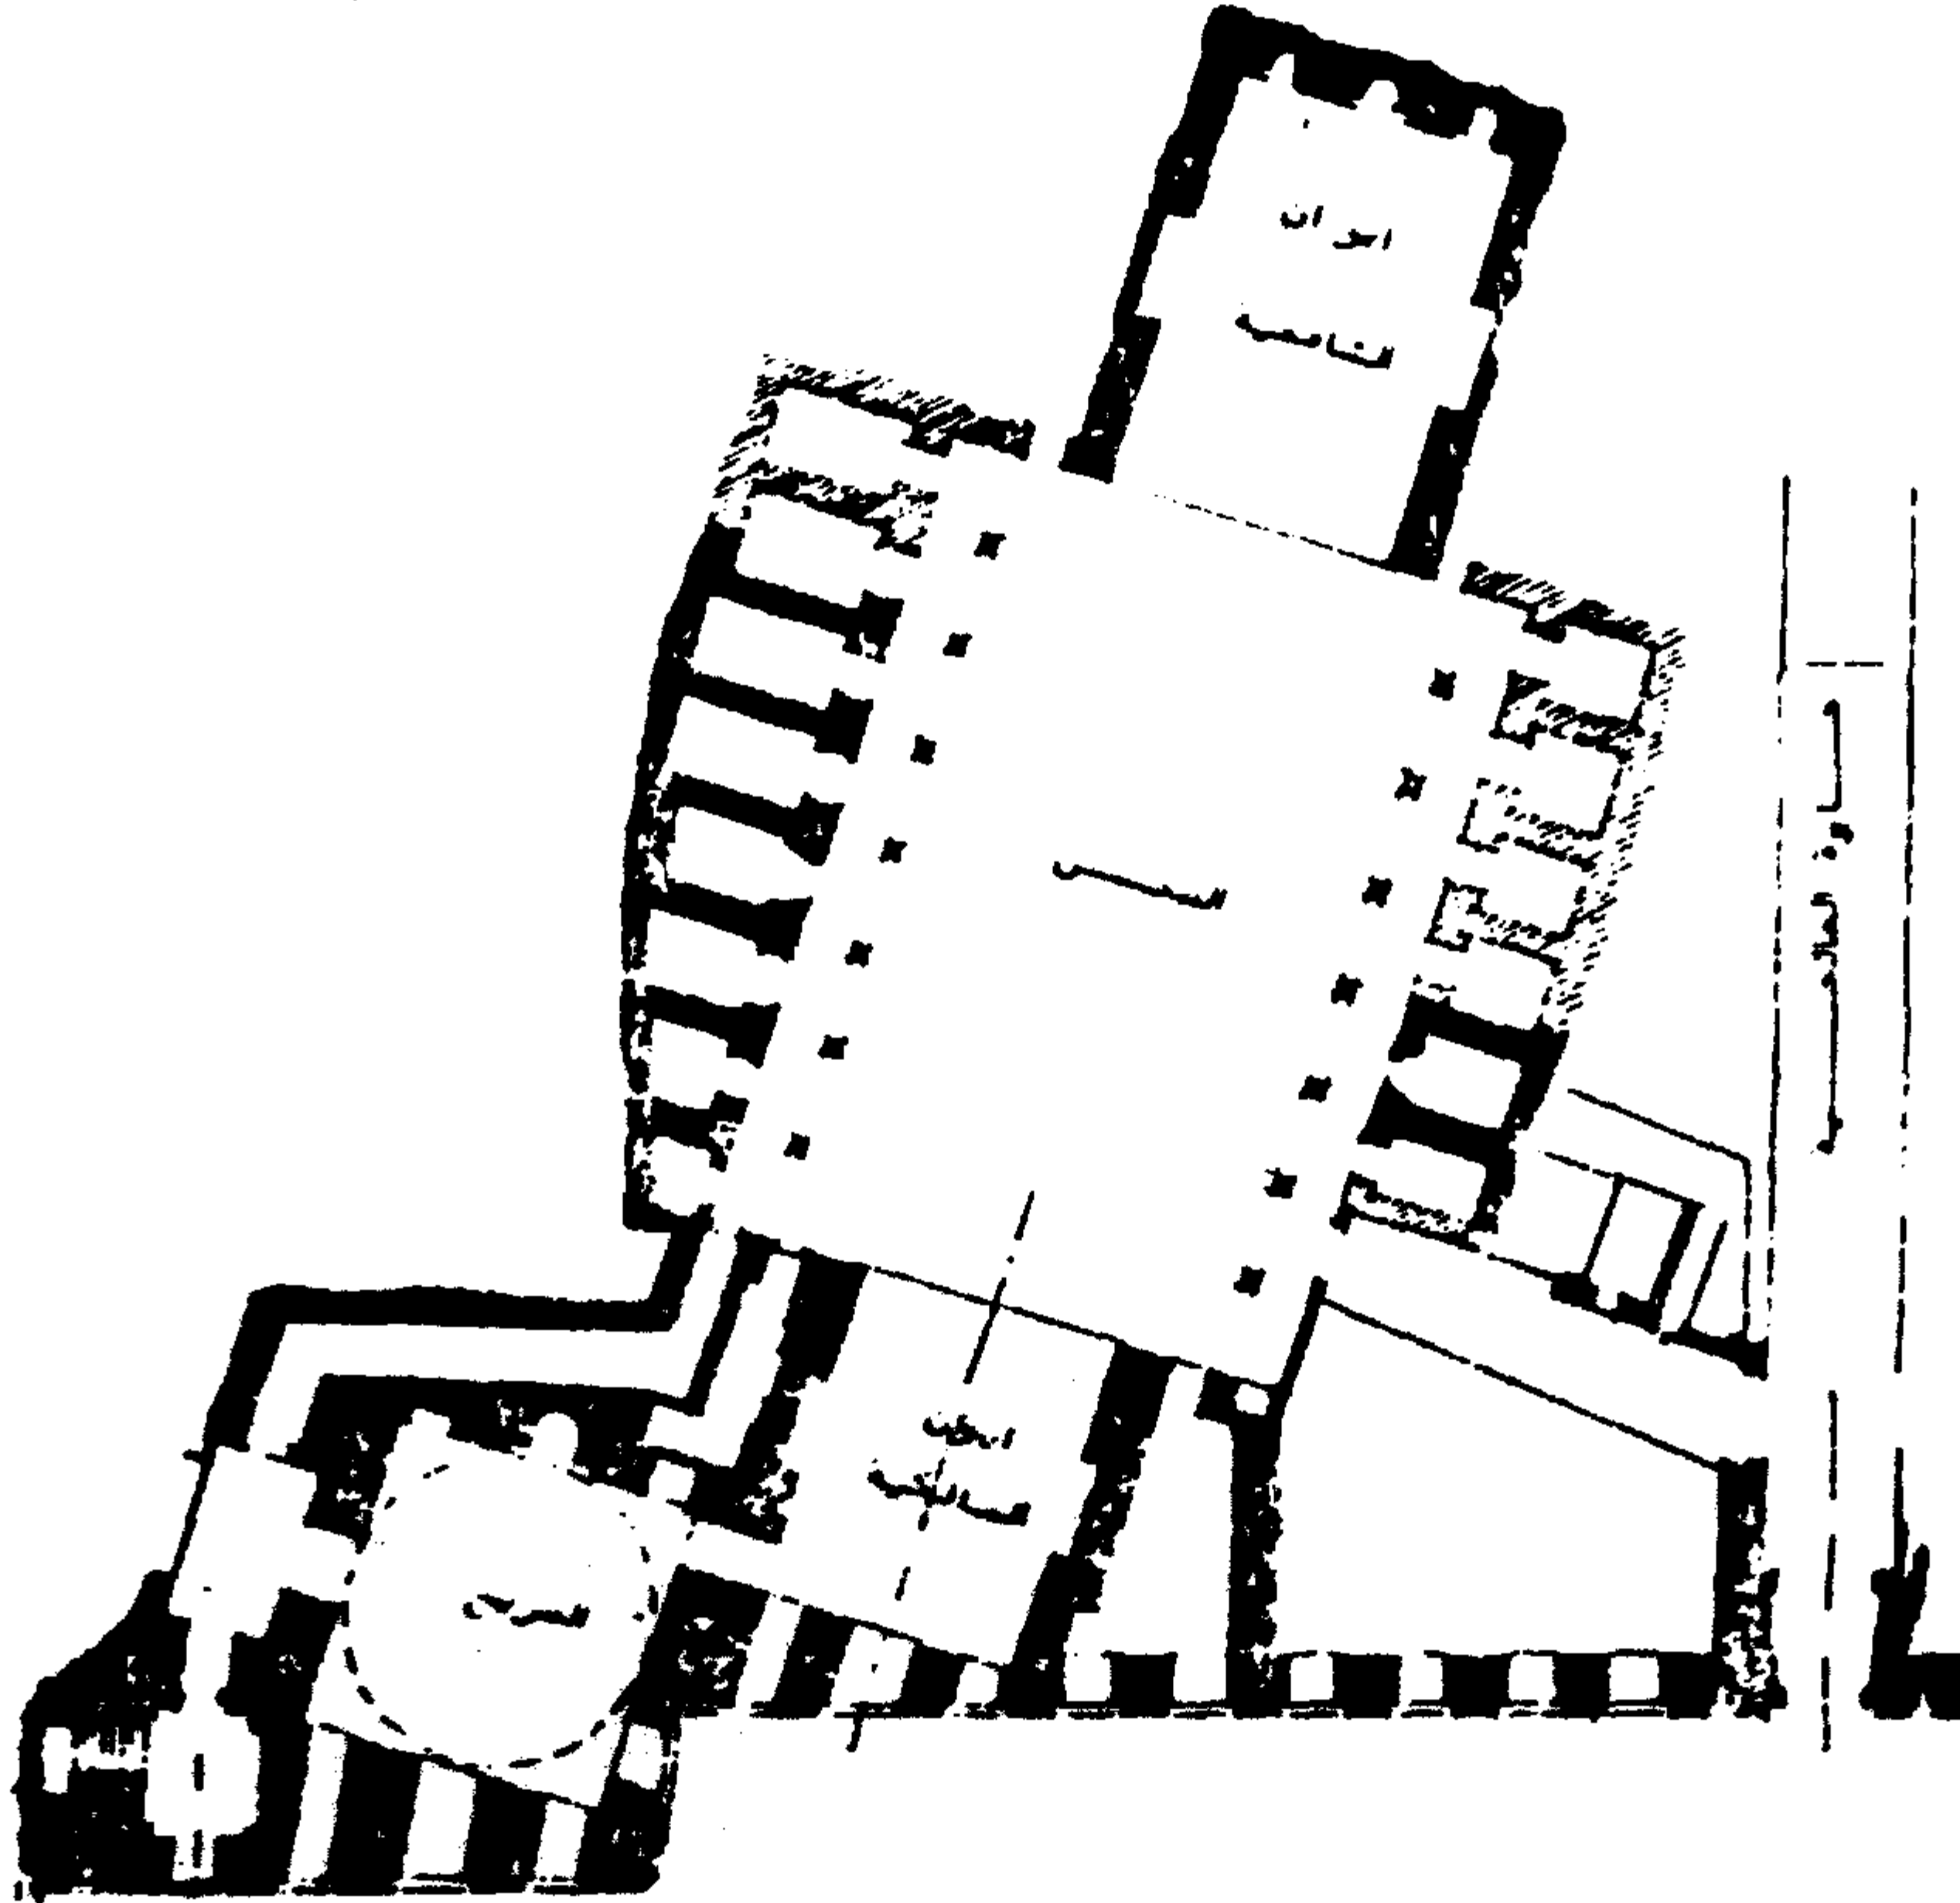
مسقط أفقي للمدرسة البكرية بصنعاء.
